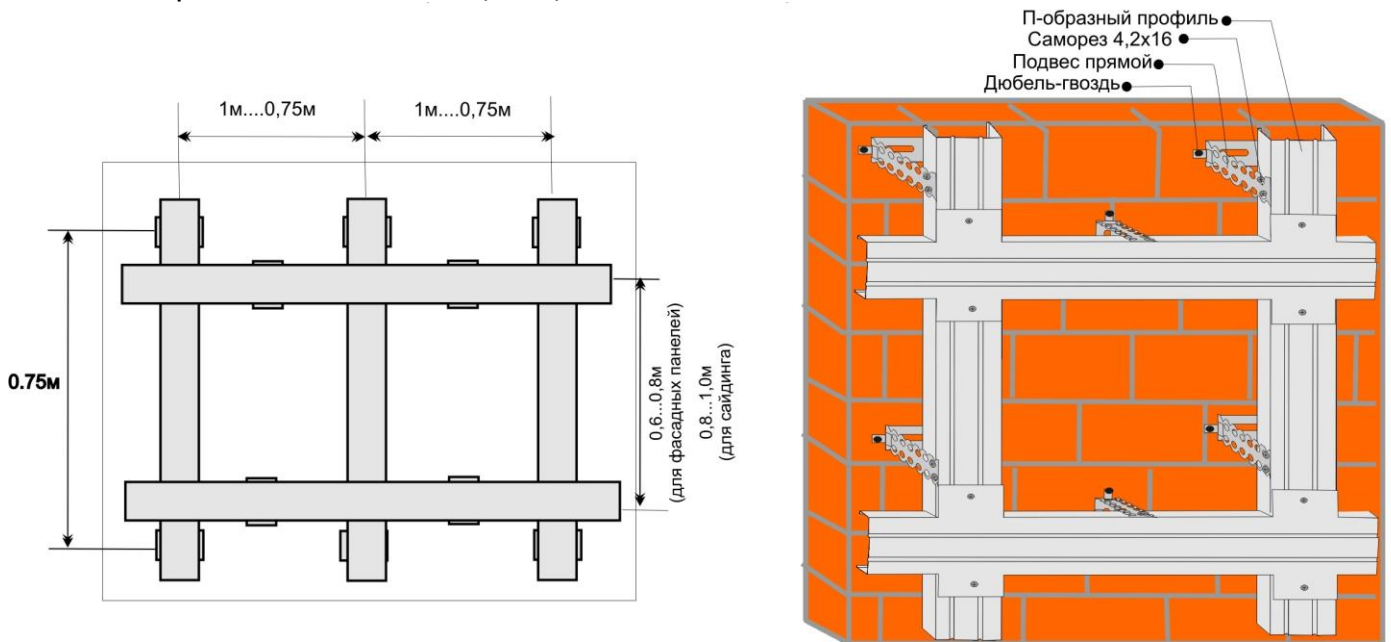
Вертикальный монтаж сайдинга и фасадных панелей
